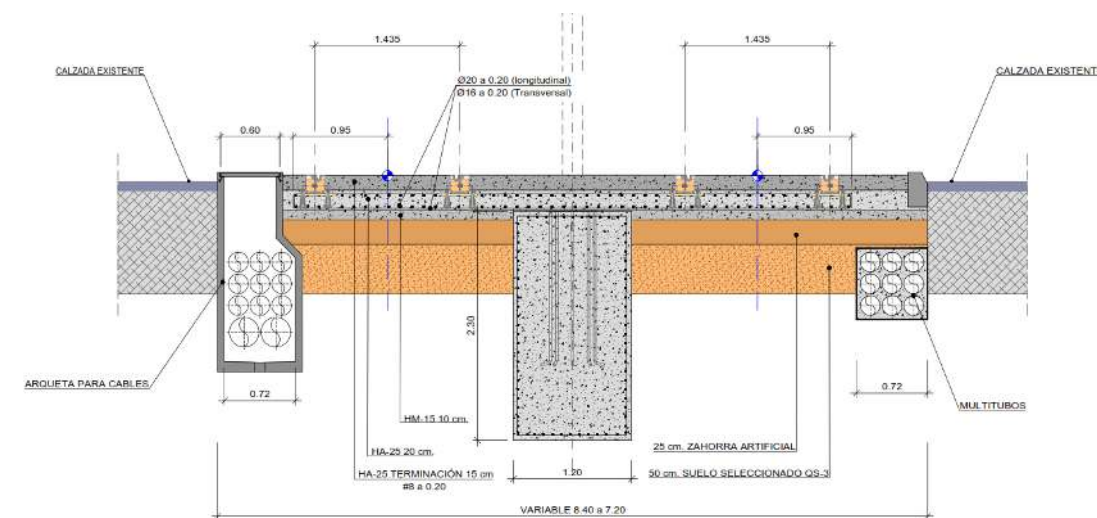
Sección tipo de vía para sección con terminación en hormigón.
